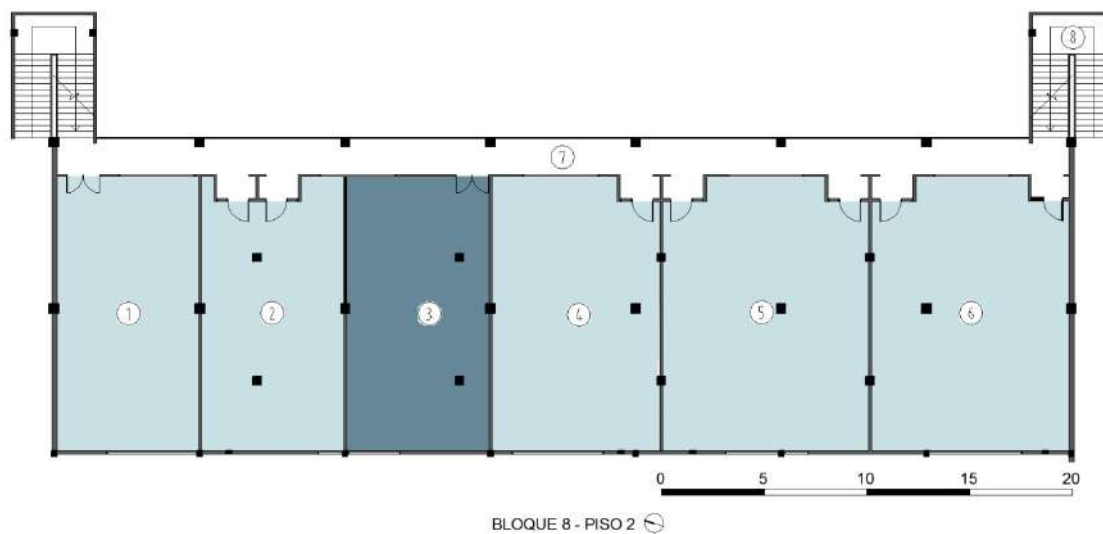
Planta Segundo Nivel Bloque No.8
